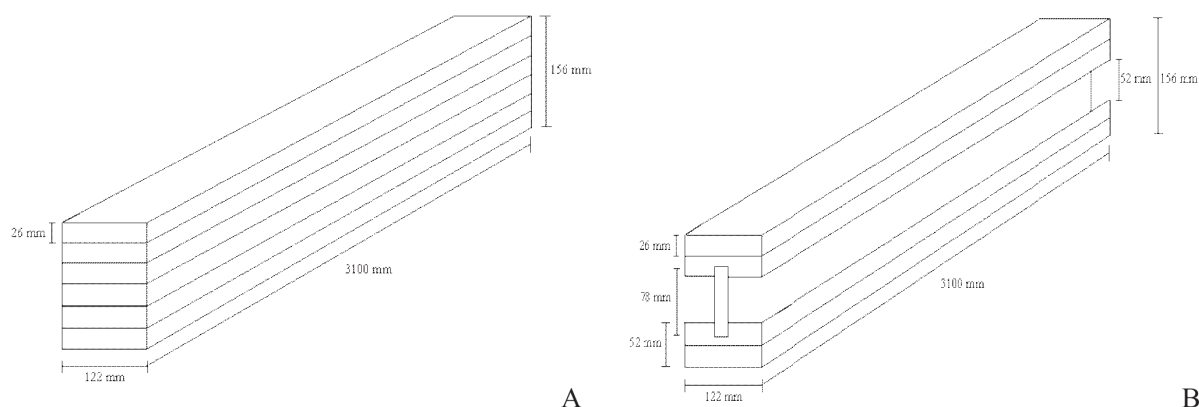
Esquema ilustrativo das vigas estruturais utilizadas no experimento. (A) madeira laminada colada; (B) viga com perfil I.
